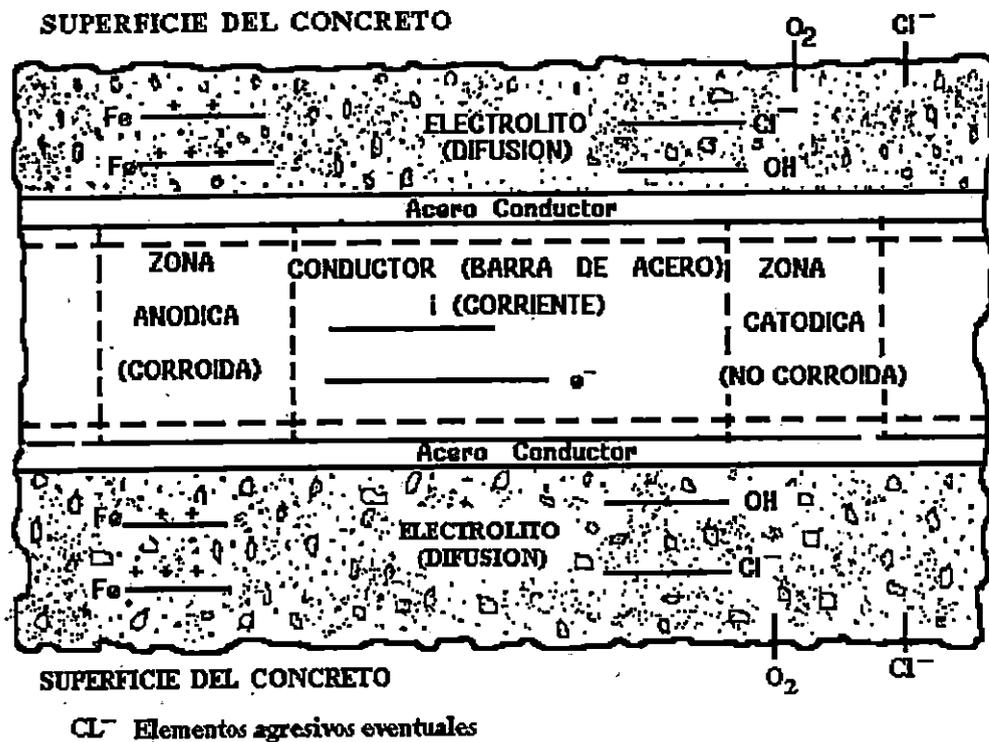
Pila de Corrosión en el Concreto Reforzado
